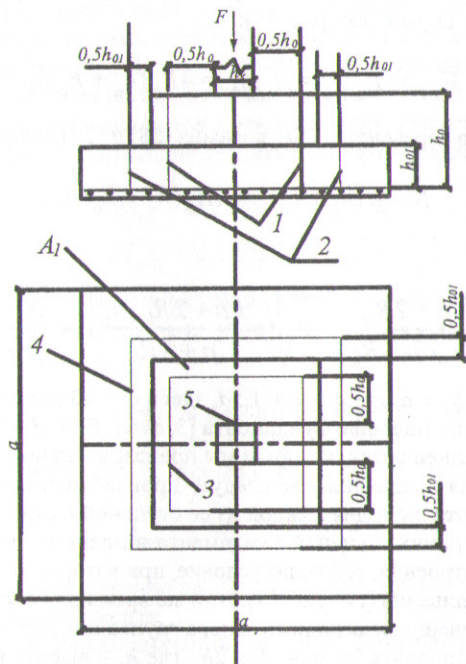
Схема расчета железобетонного фундамента без поперечной арматуры на продавливание:
